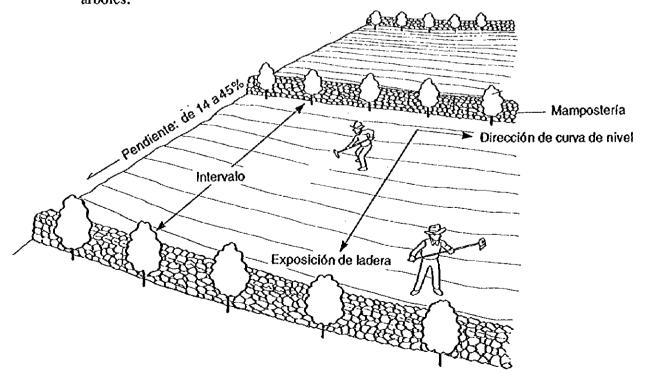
Esquema Conceptual de Mampostería y Plantación de Arboles
